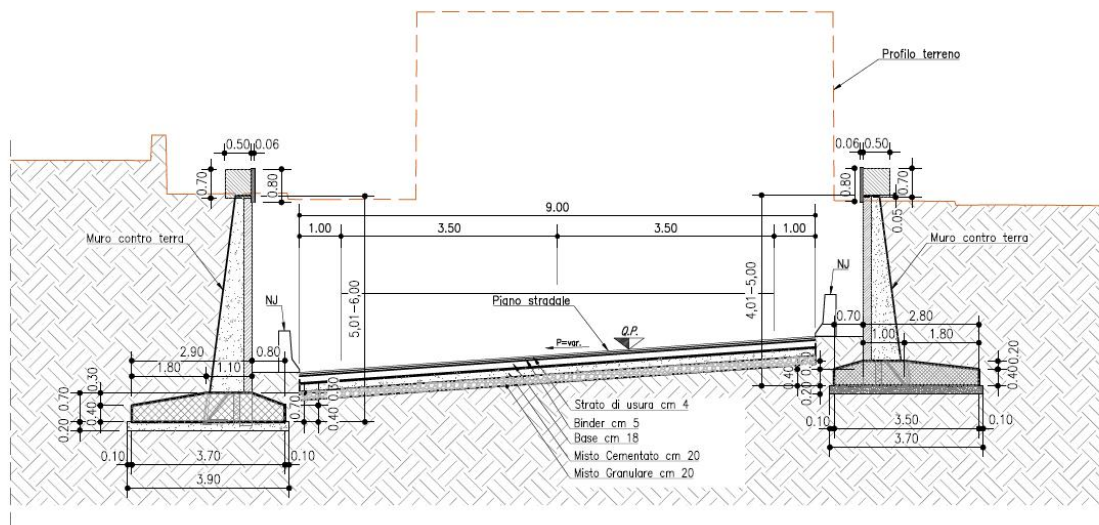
Sezione di progetto tratto C (documentazione fornita dalla committenza)
